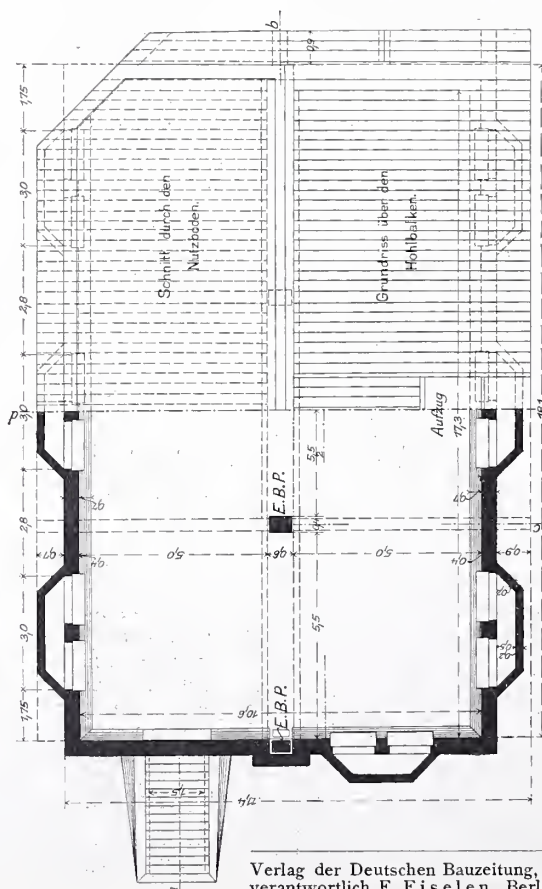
Grundrisse vom Keller und Erdgeschoß.
